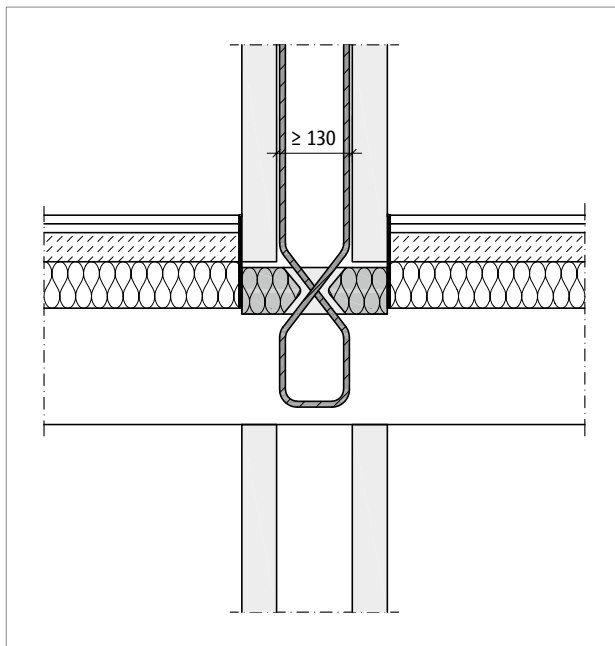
Schöck Sconnex® Typ W: Schematische Darstellung Schöck Sconnex® Typ W bei Doppelwänden und Aufdeckendämmung
